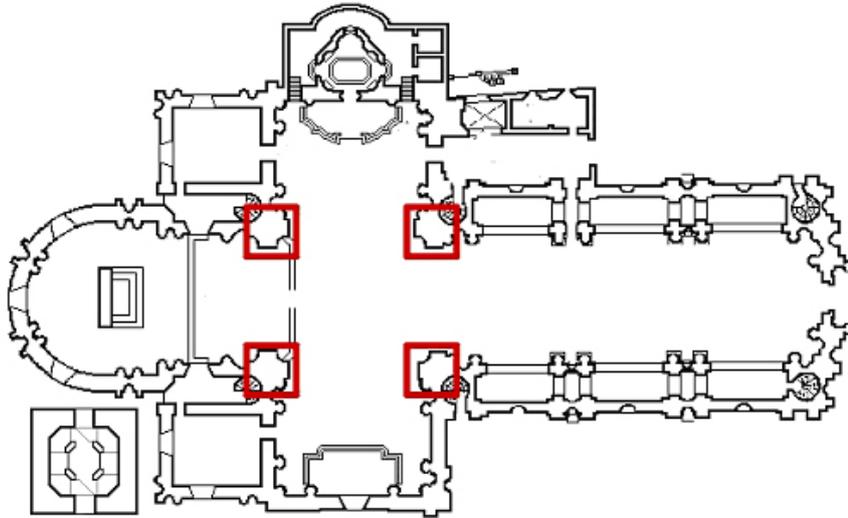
Planta de la basílica donde se observan los pilares en los vértices del trancpto.
